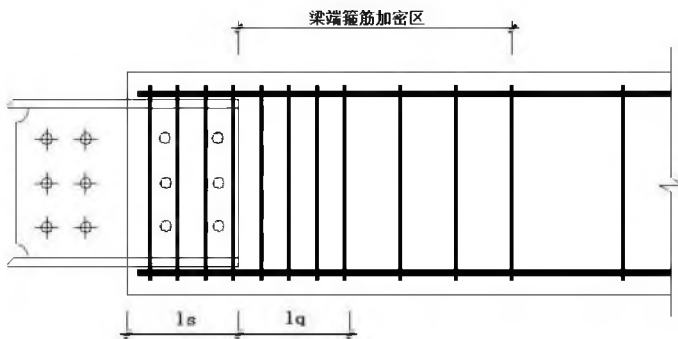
预制钢筋混凝土梁端部构造示意图
